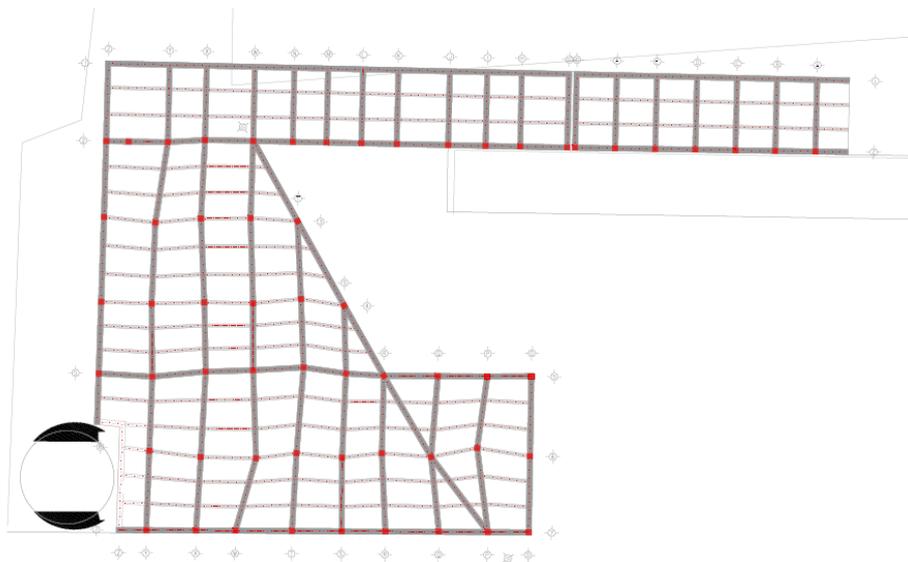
Planta general del Muelle de Maura en el proyecto de Gutiérrez y Chamizo [16].
